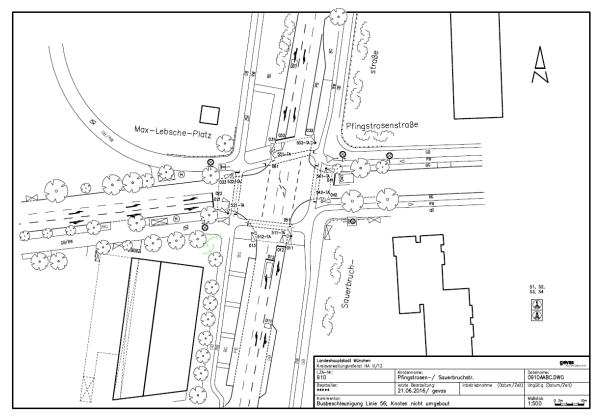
Signallageplan LSA Pfingstrosenstraße/Sauerbruchstraße
